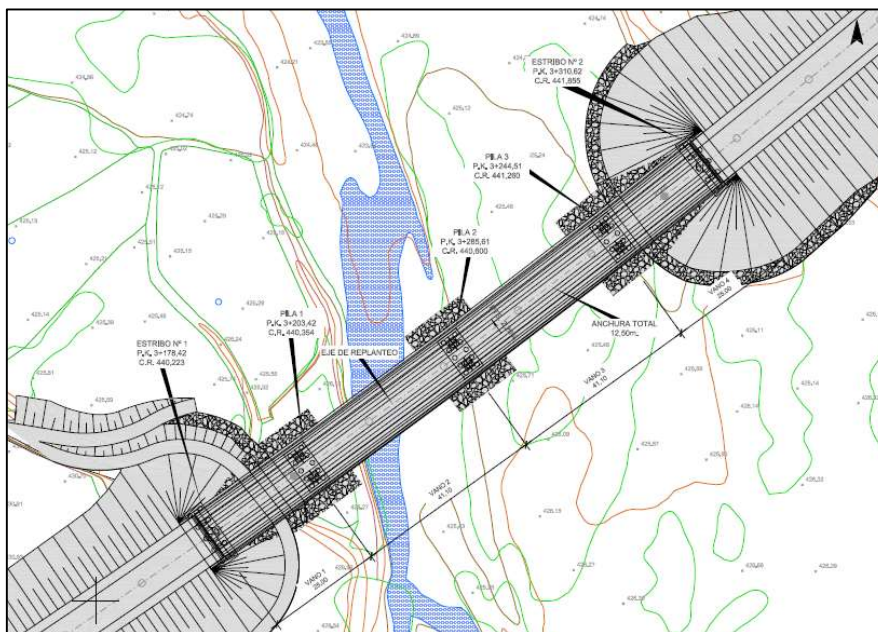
Planta general Viaducto sobre río Jubera. (Fuente: Proyecto original)
